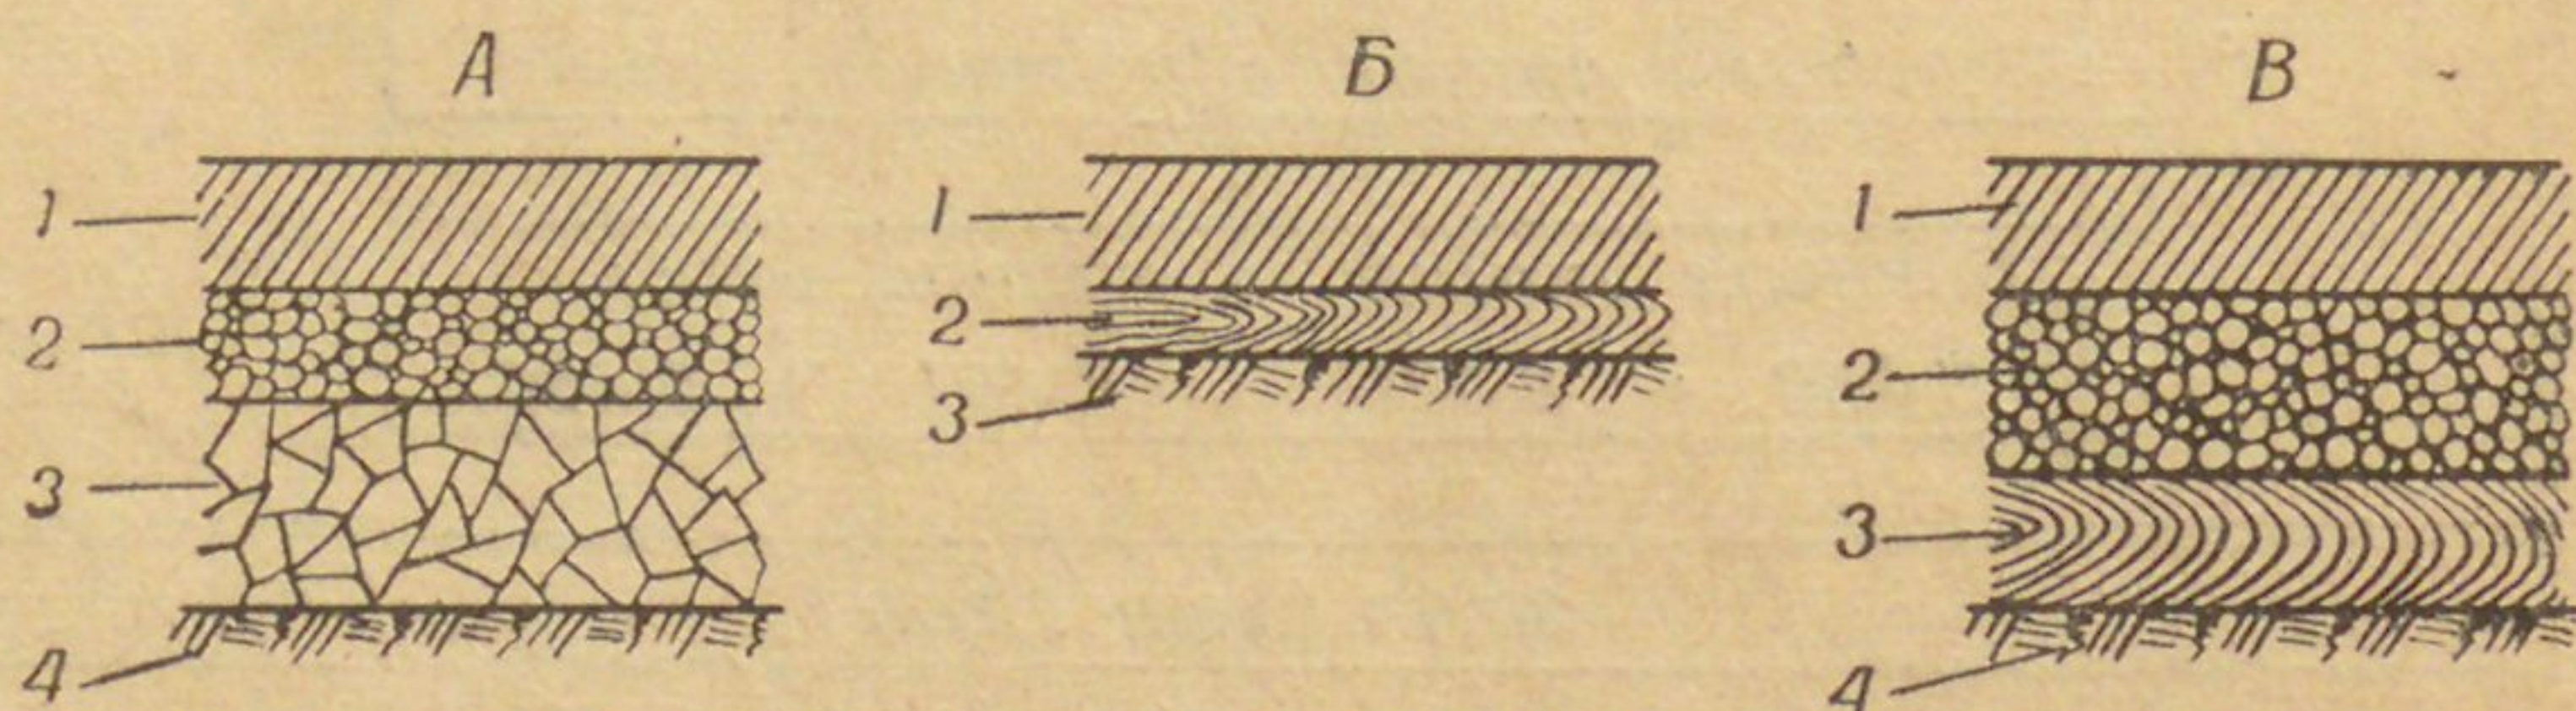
Конструктивный разрез полотна с нежестким покрытием из неводостойких грунтовых смесей
